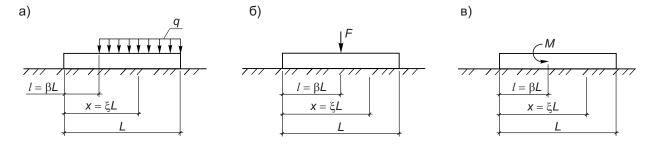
Схемы загружения балок различными нагрузками:
